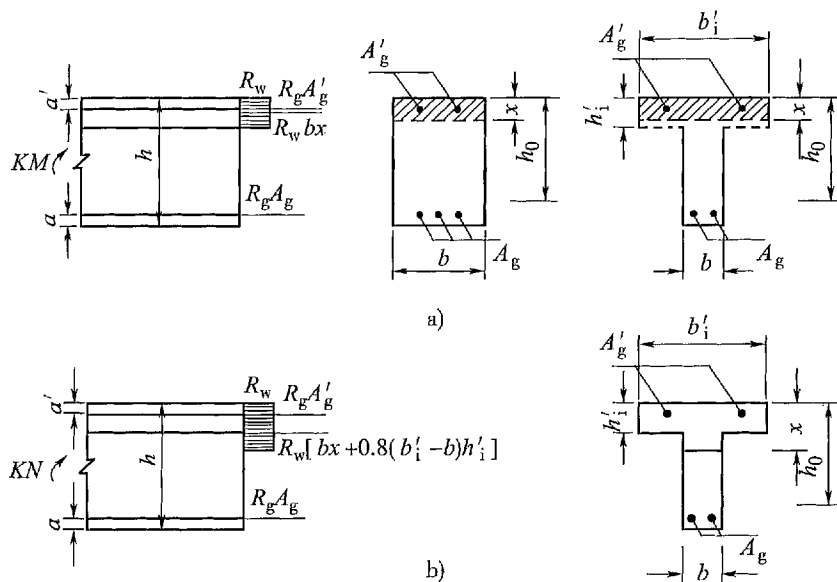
钢筋混凝土受弯构件截面强度计算
